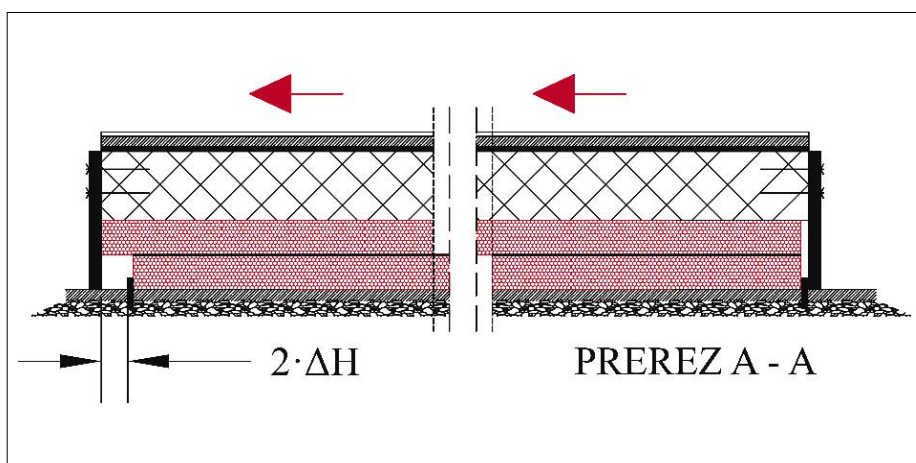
• Shematski prikaz (tloris in detajl) predlaganega sistema temeljenja
